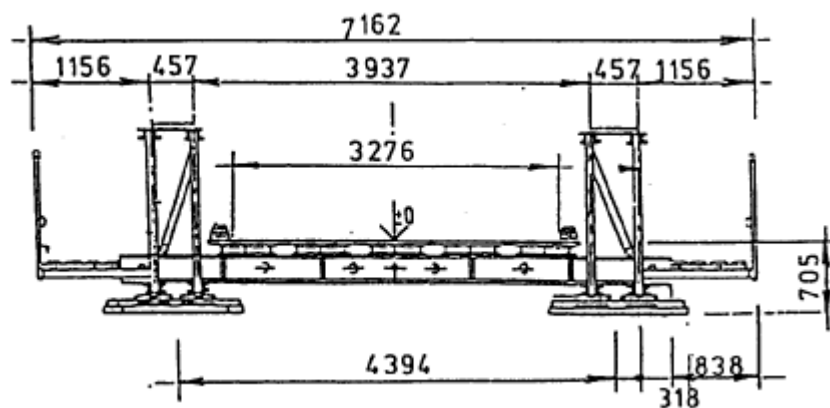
Priečný rez mostom Bailey Bridge typu JJ
